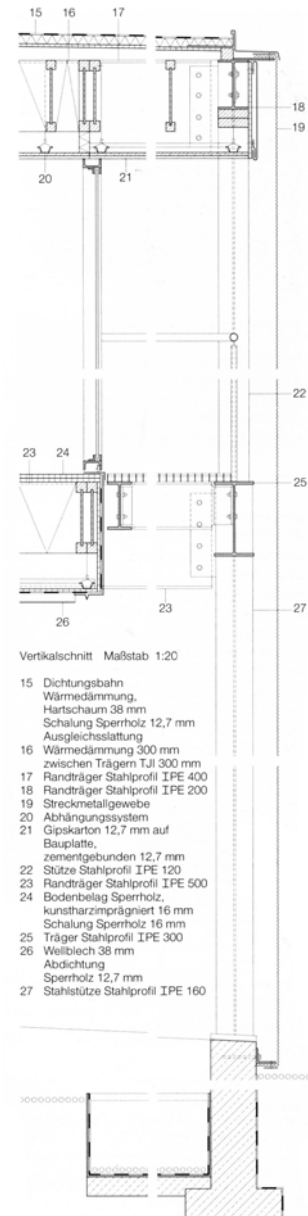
Fassadenschnitt Wohnhaus Phoenix
